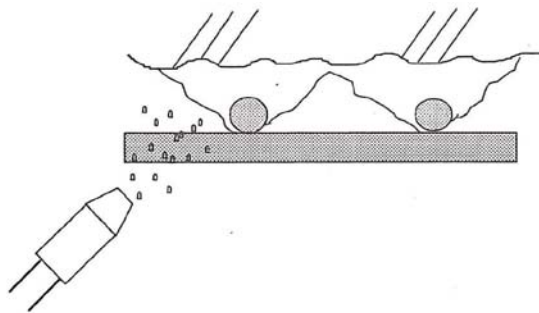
(3) 吹付け工法 (湿式) による断面修復の施工概念 (出典:「⑥設計施工指針 (案)」)
